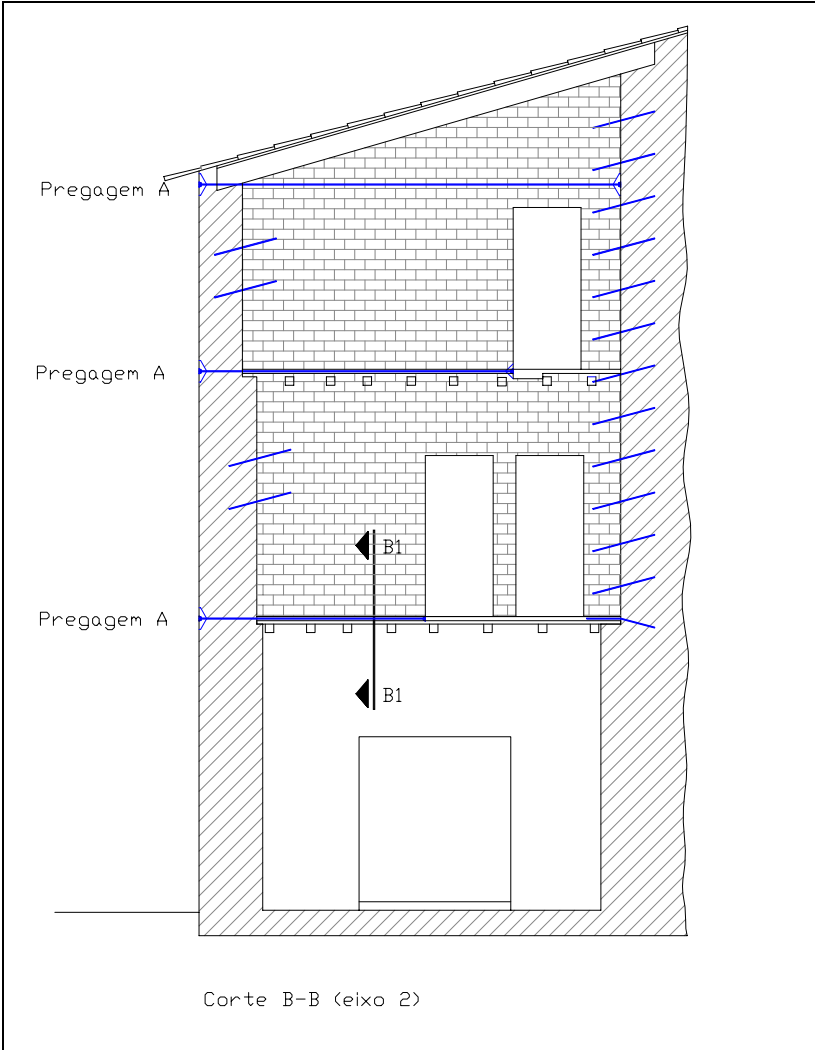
Parede transversal de contraventamento. Pregagens empena-contraventamento.
